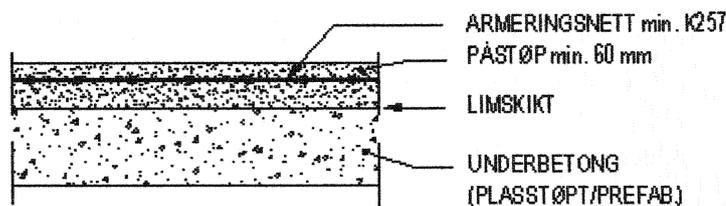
a: Påstøp av betong på underlag av betong.
